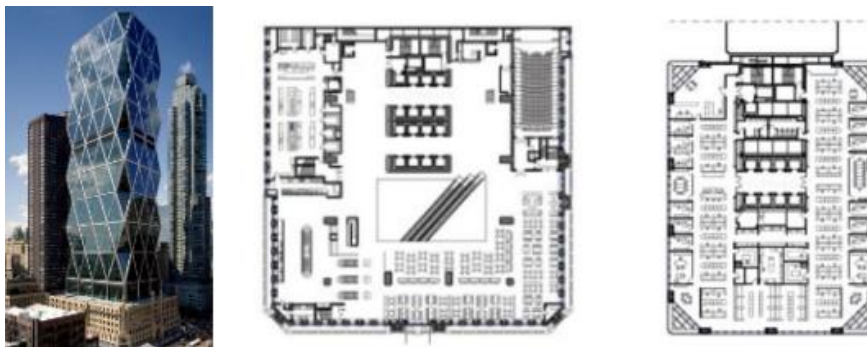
Hearst Tower e sua planta do átrio e da torre [10]
